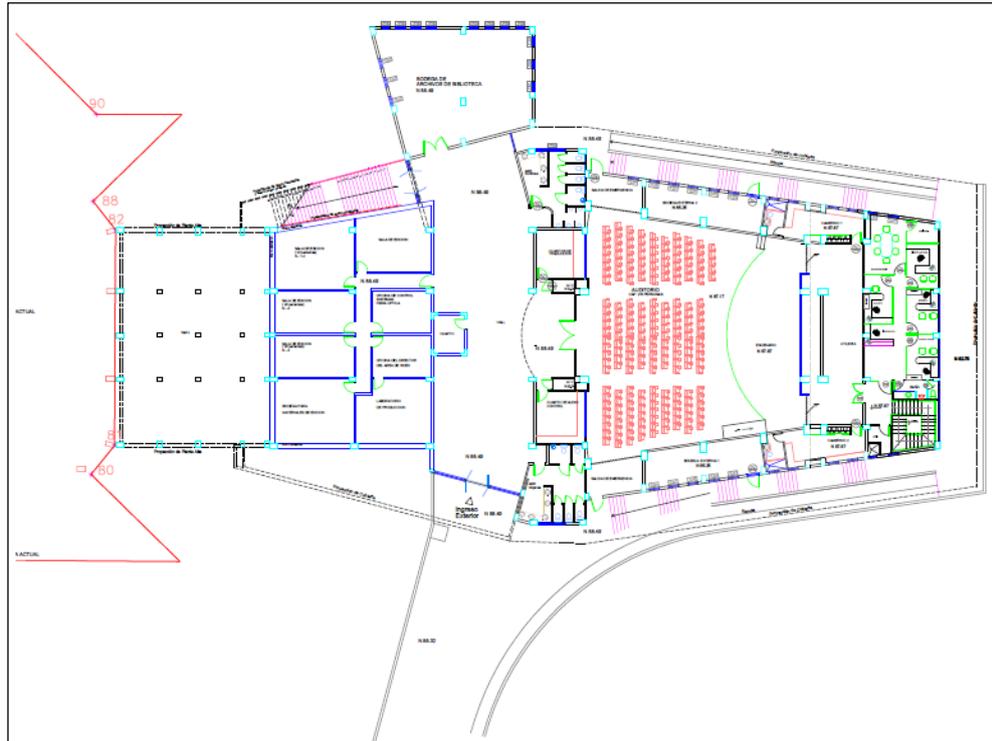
Planos, Ampliación de Edificio-Planta Baja, Zona 6
